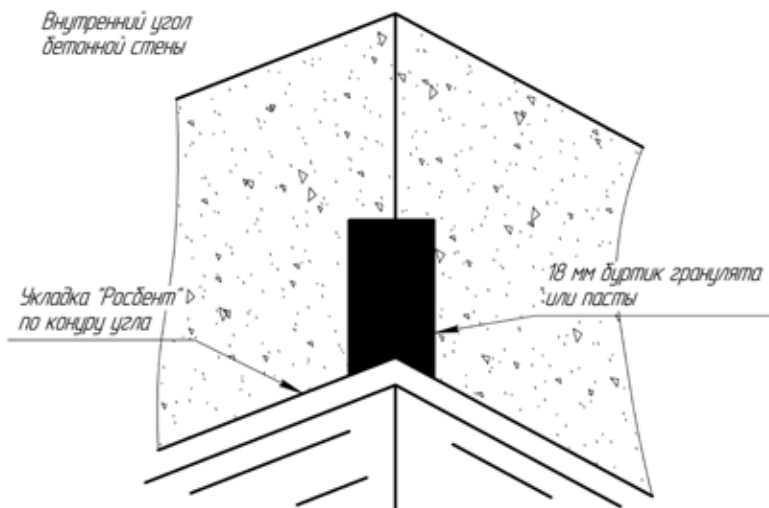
Гидроизоляция внутреннего угла, образованного стенами и фундаментной плитой
